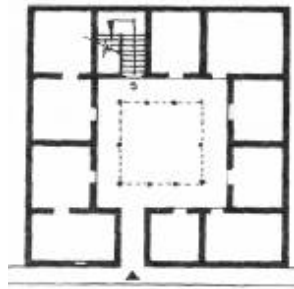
Esquema de planta baixa térrea de casa da região de Sevilha.
